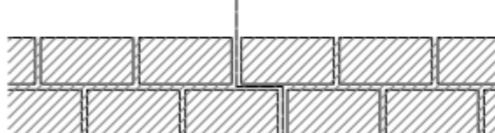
Junta de movimiento con solape. Esquema en planta
